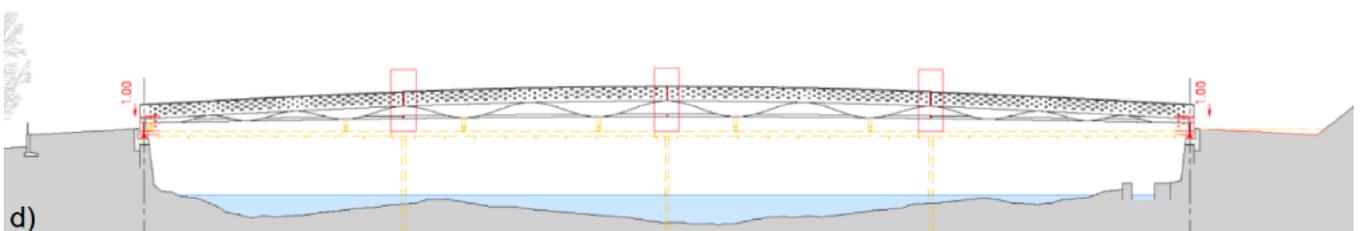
Schnitt Verschweissung der Elemente und Rückbau der Hilfsbrücke
